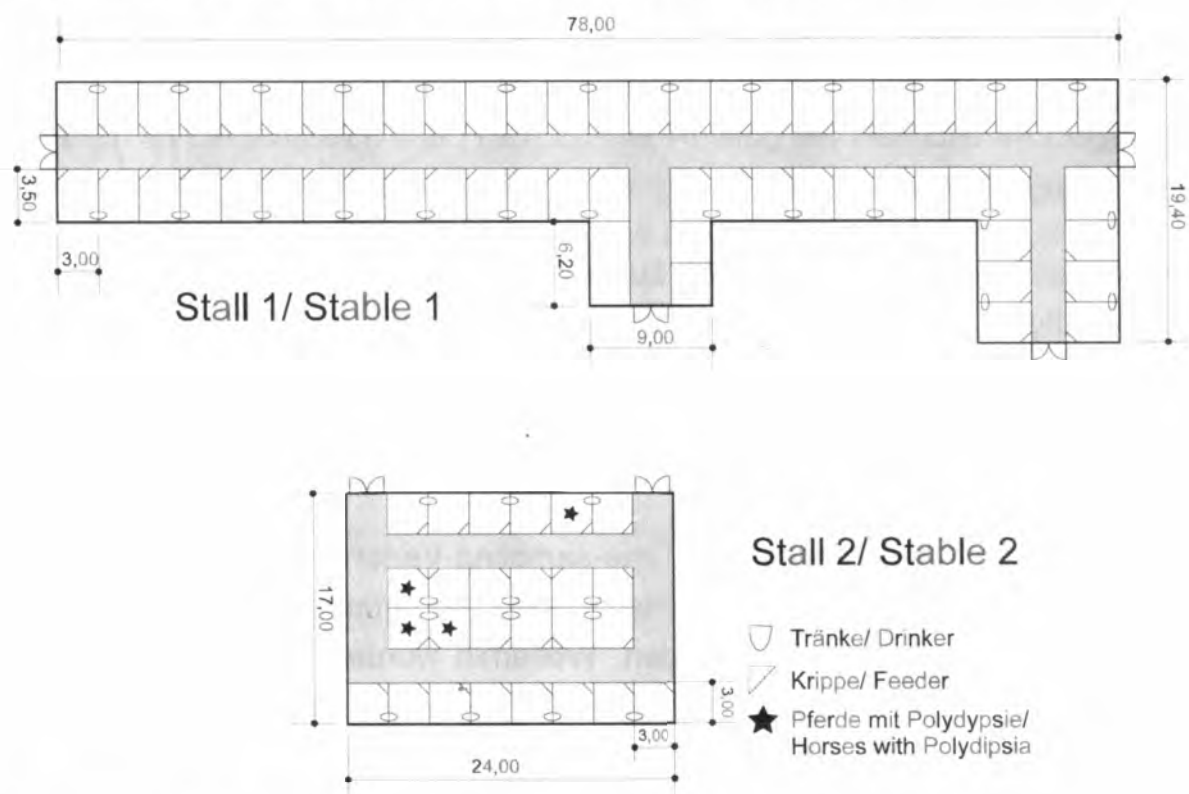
Einzelhaltung: Grundrisse (m) der Stallgebäude, Betrieb B
